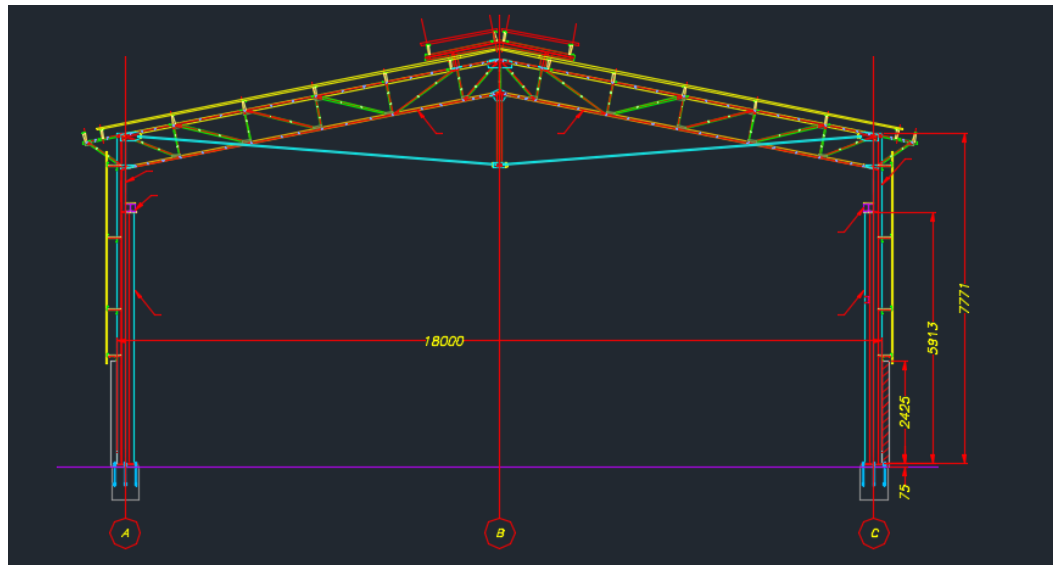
Vista lateral del diseño estructural de la bodega. Fuente: Planos de la bodega.
